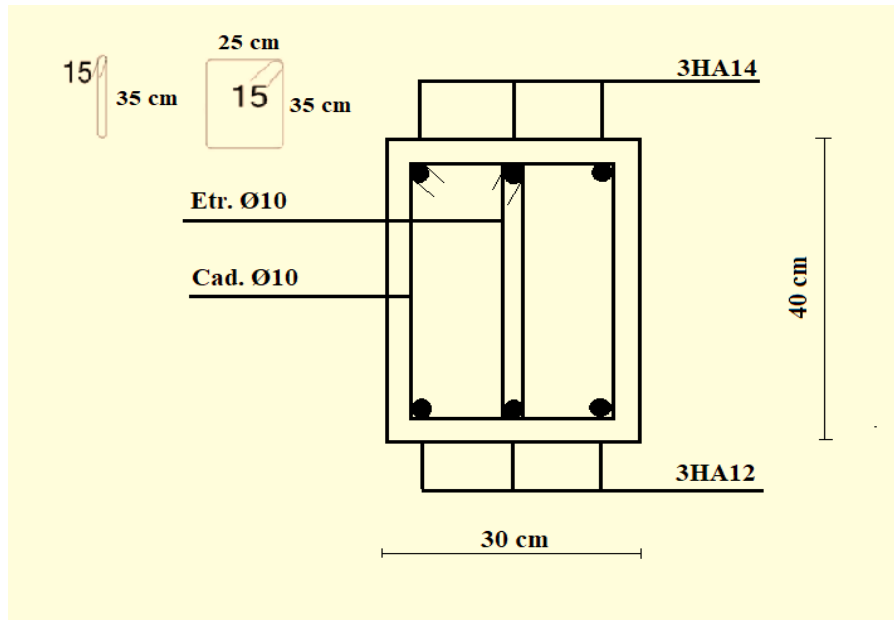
Ferrailage des poutres secondaire au niveau de la travée pour 8^{ème} étage
